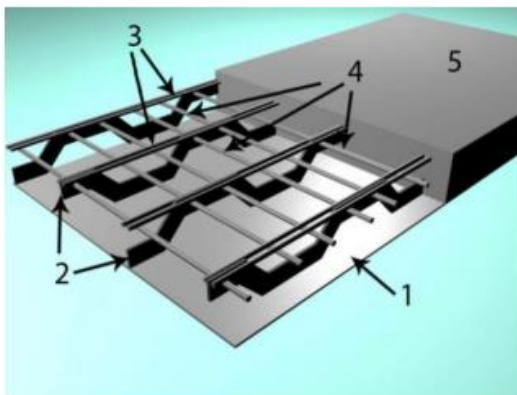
Сталежелезобетонная конструкция с упрочняющими элементами: 1 – стальной лист; 2 – упрочняющий элемент; 3 – продольная арматура; 4 – поперечная арматура; 5 – бетон
